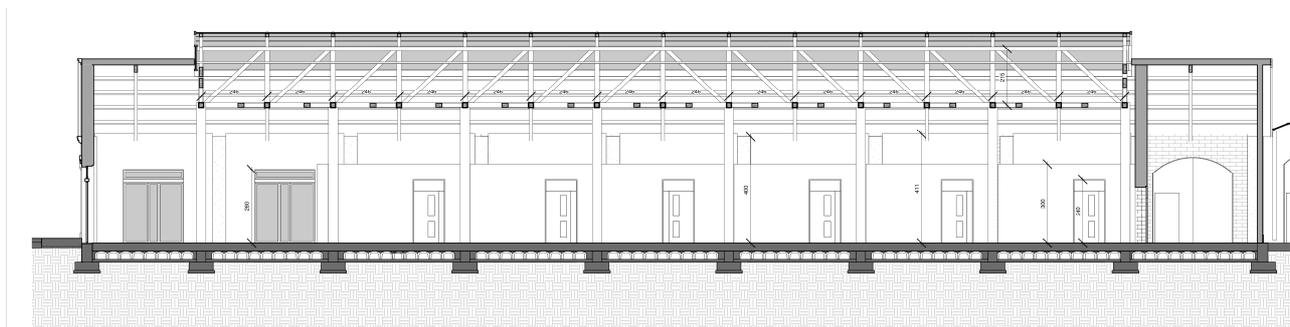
Sez. D-D Fab-lab (Tav. n° 9 scala 1:100)
